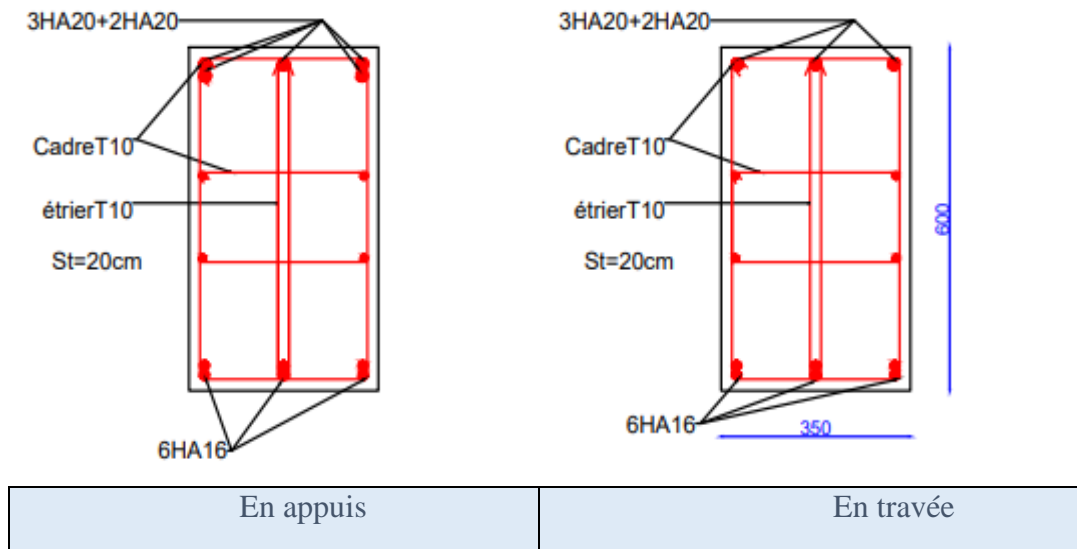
Schéma de ferrillage de la poutre brisée.
